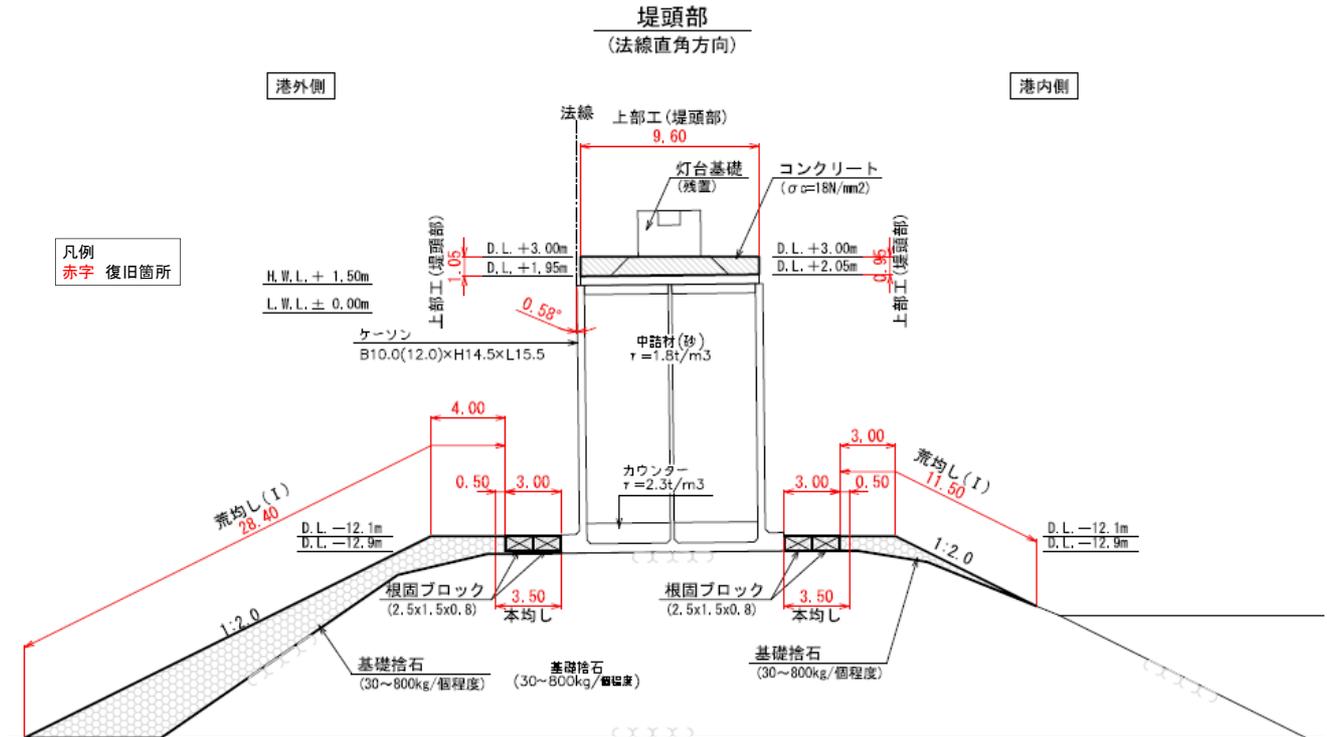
No.1 常陸那珂港区_北防波堤断面図(堤頭部①)(復旧後)
